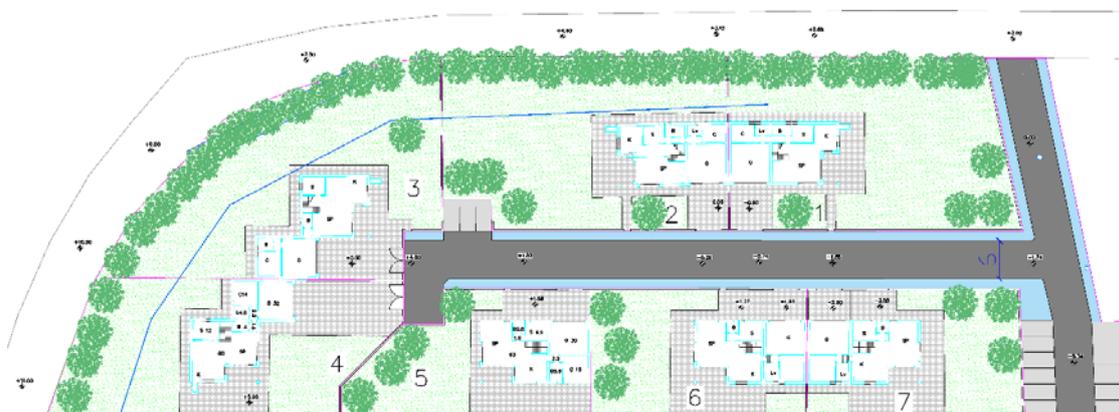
Planimetria nuovo insediamento residenziale in progetto
